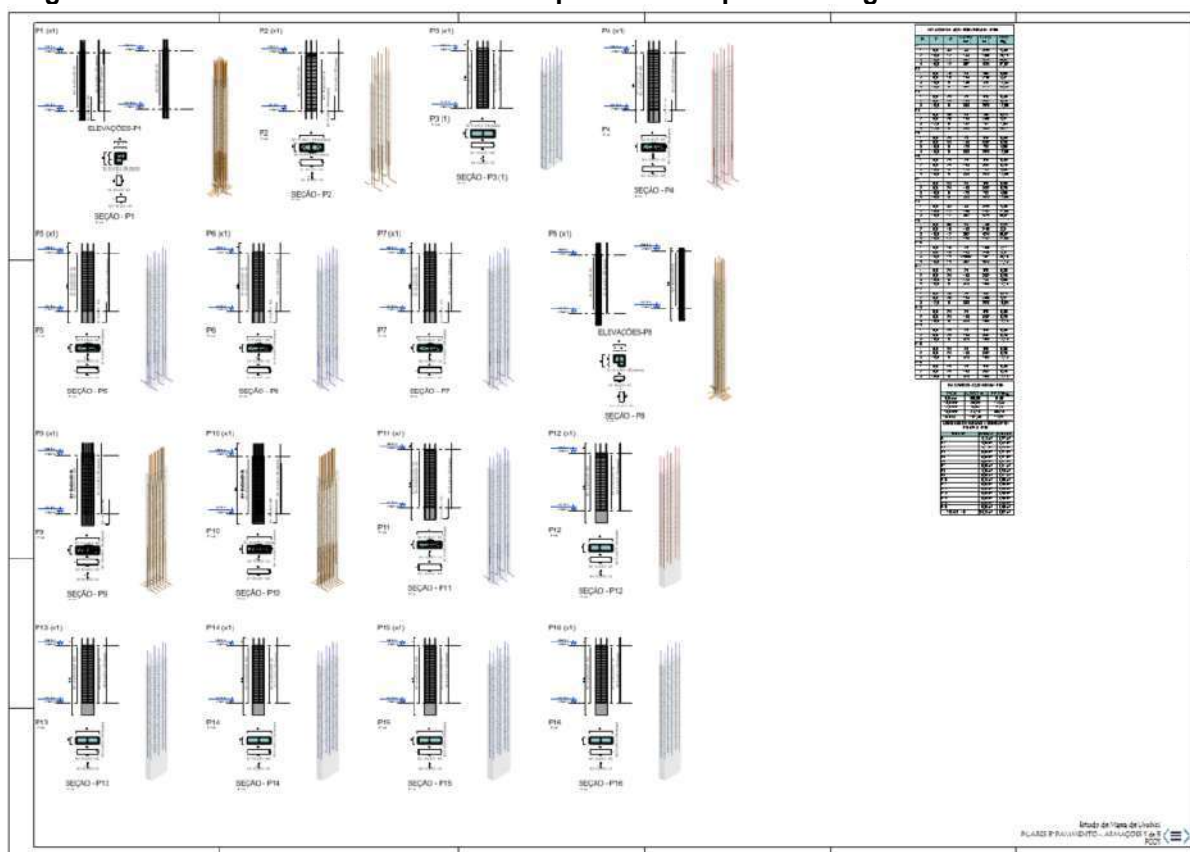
Localização das pranchas de detalhamento dos pilares do 3º pavimento.
